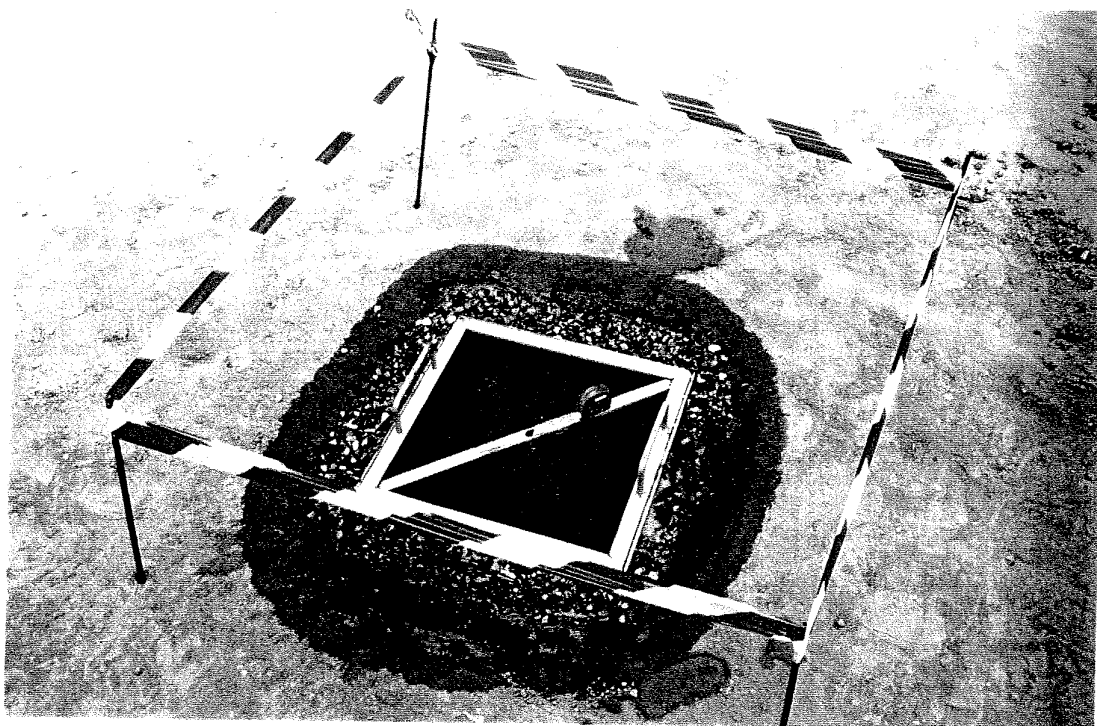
Particolare del pozzetto superficiale per la prova di permeabilità
